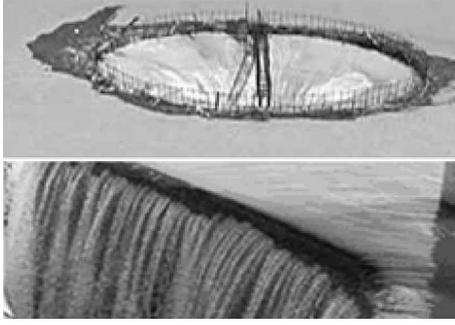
Воронка над заполненной трубой водосброса Неберджаевского водохранилища (верхний кадр). Сток воды по стенкам водосброса (нижний кадр)
